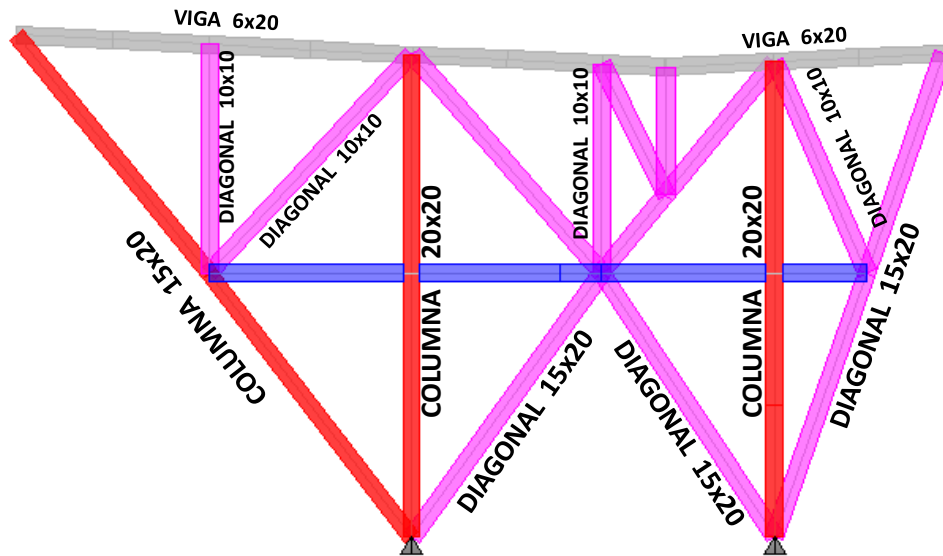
Definición secciones de vigas y columnas vivienda de guadua laminada
